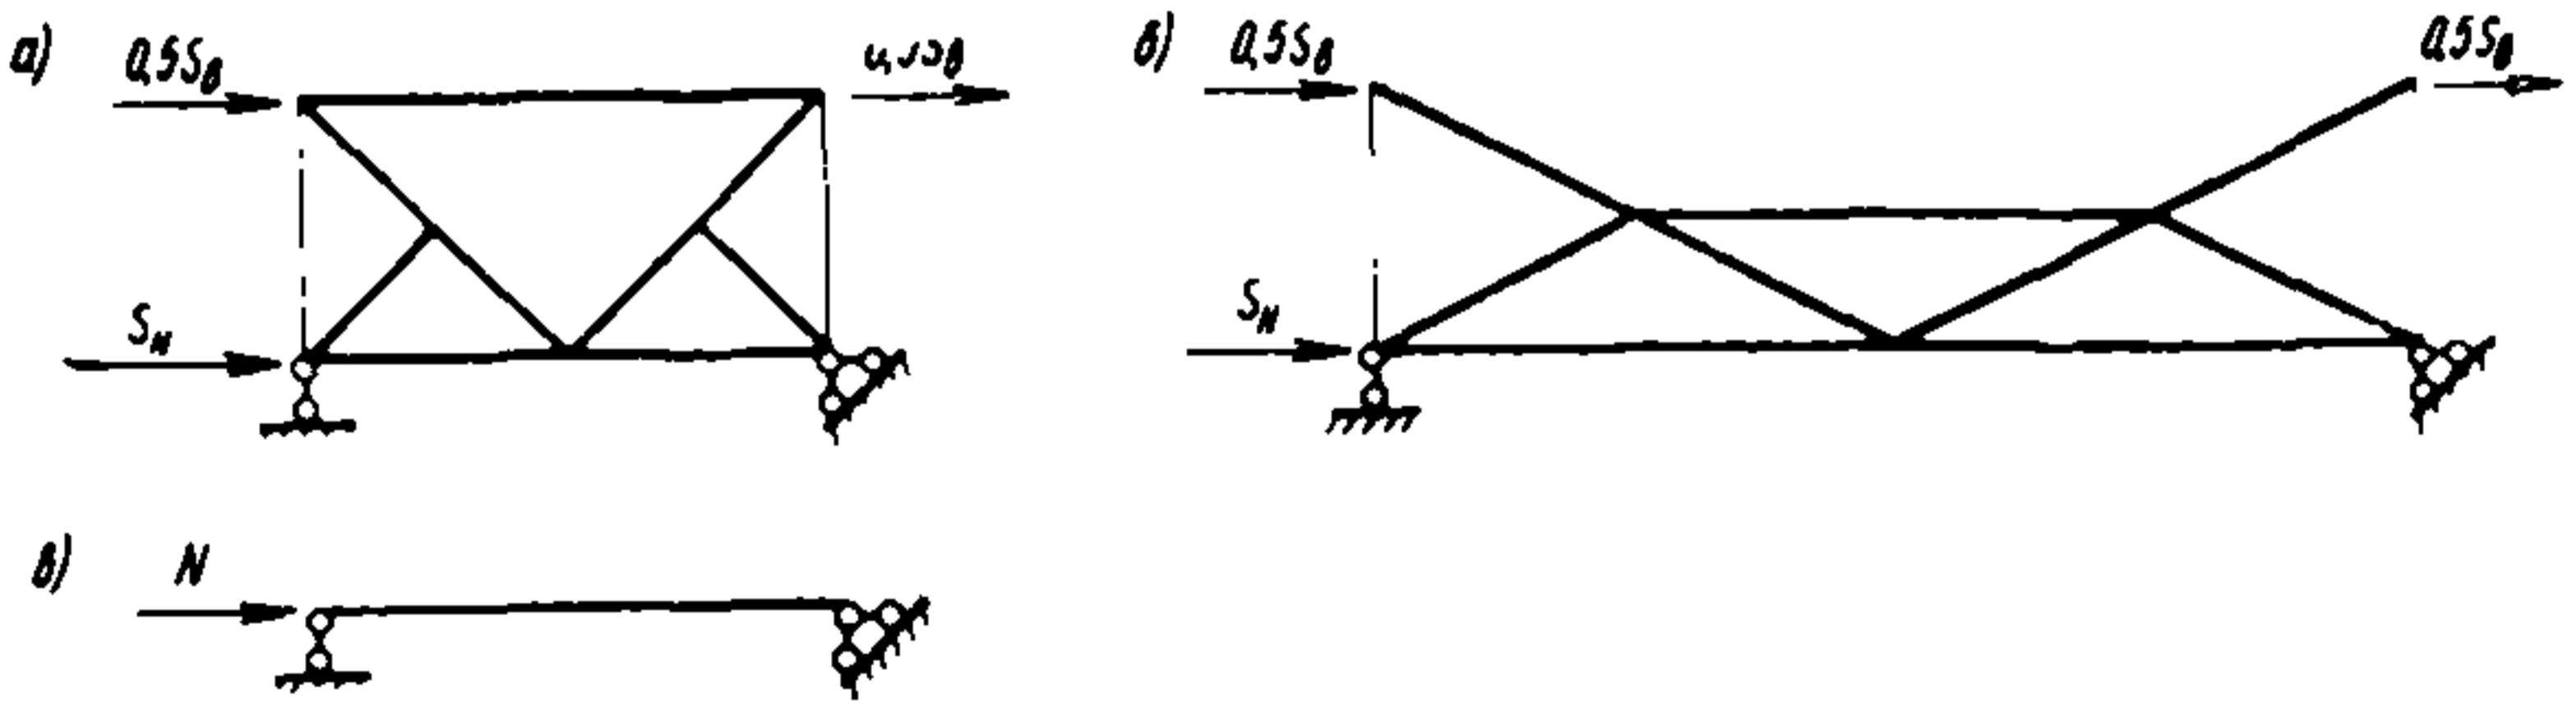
Расчетные схемы вертикальных связей между опорными стойками стропильных ферм с шагом 6 м (а) и 12 м (б) и распорок (в) покрытий из стального профилированного настила
